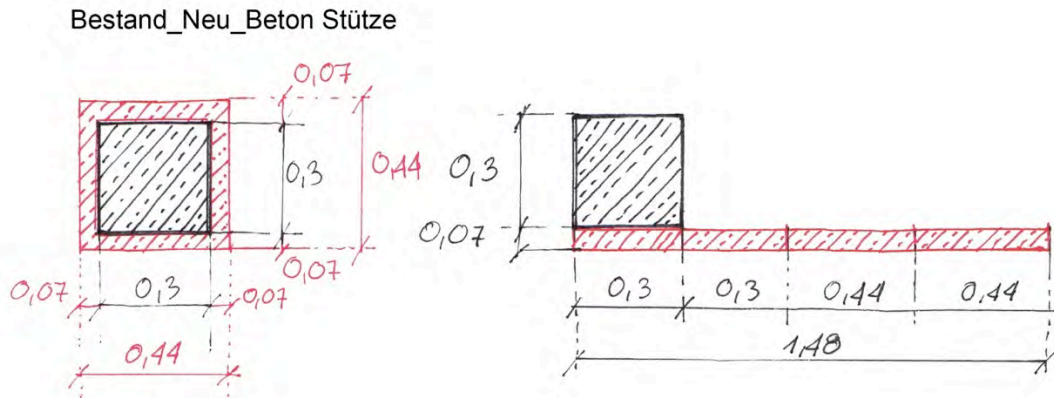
Stütze mit Abwicklung, Bestand und Neu Stahlbeton
